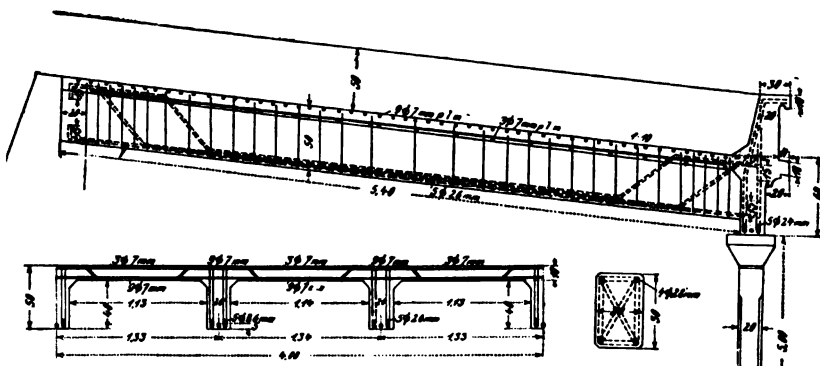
Querschnitt und Längenschnitt sowie Armierungspläne der Galeriedecke zwischen Auzza und Canale.
